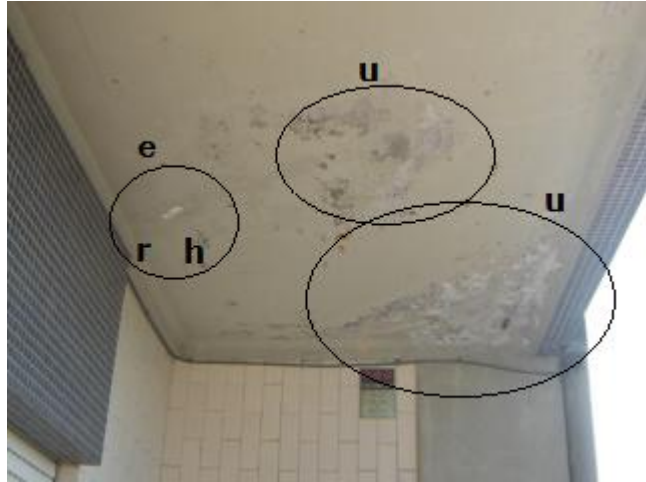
Infiltração, fissuras e destacamento no tecto da varanda “e; r; h; s; f; u”
